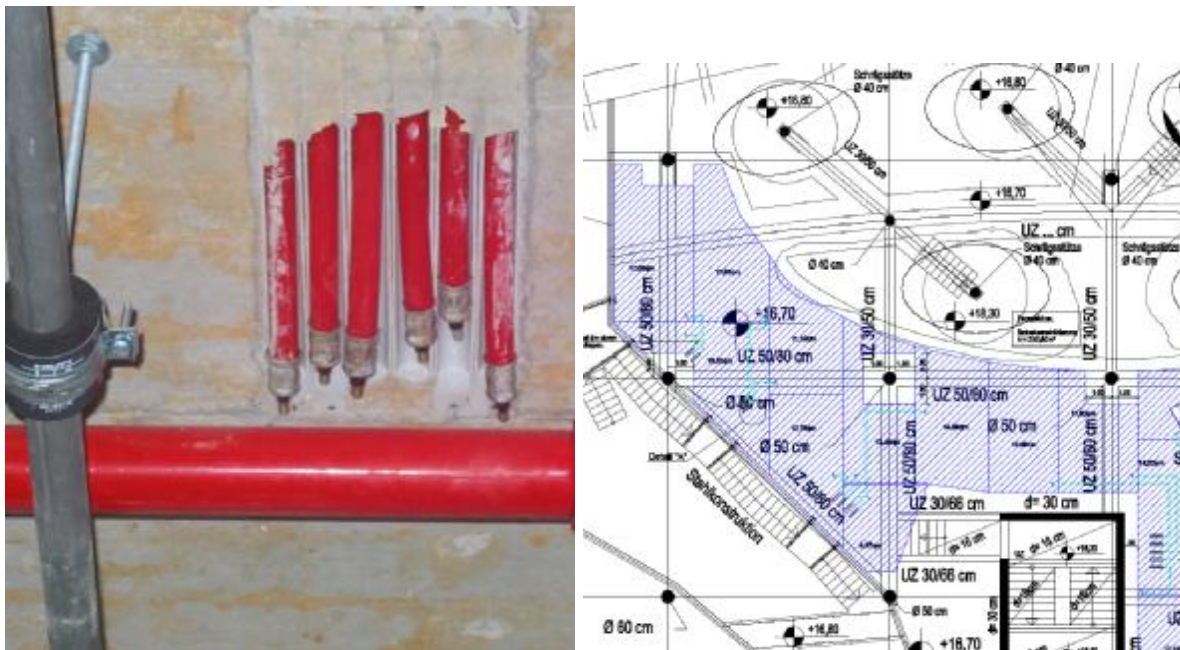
Beispiel Anschlussdetail Deckendurchführung der Rohrregister in der Betondecke (links) und Belegungsplan Bauteilaktivierung (rechts)
